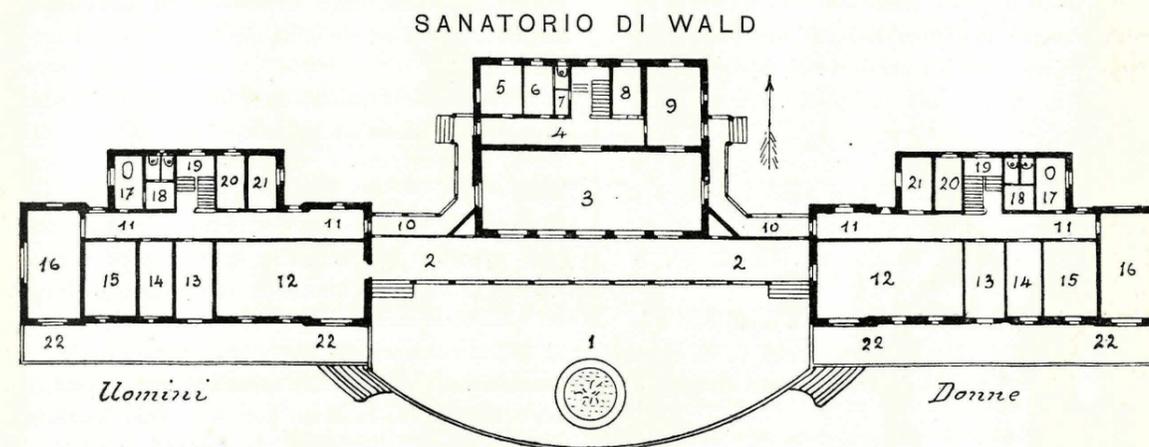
Pianta del pianterreno (Scala 1:500).
